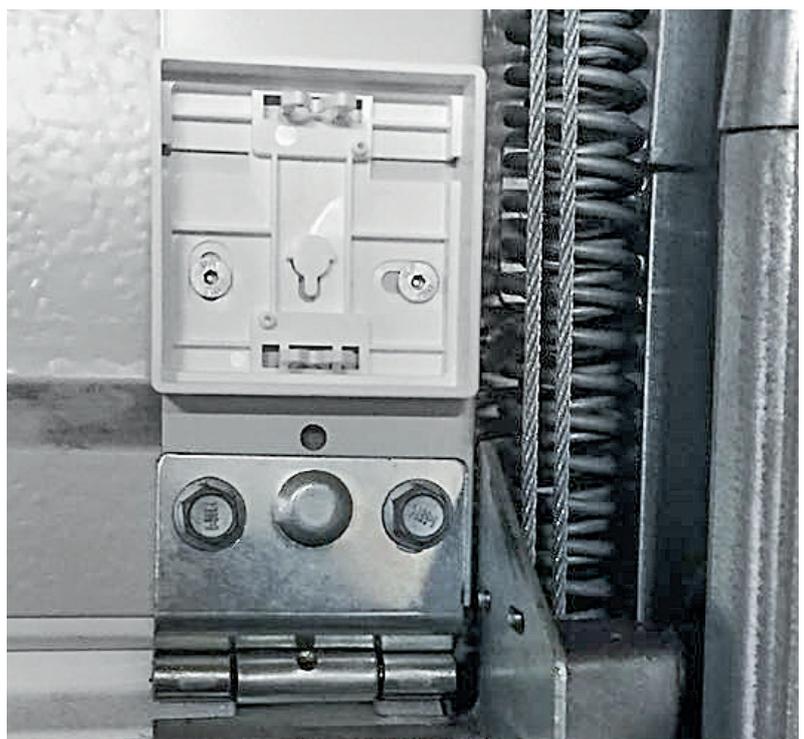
Montagebeispiel für die Schraubmontage an einem Garagentor
